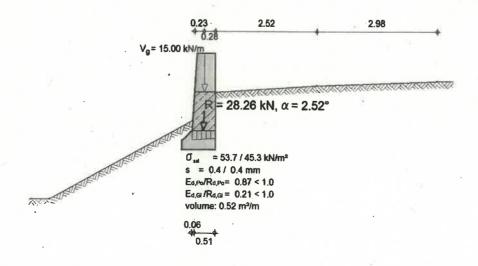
Estratto dello studio sulla stabilità del nuovo muro
